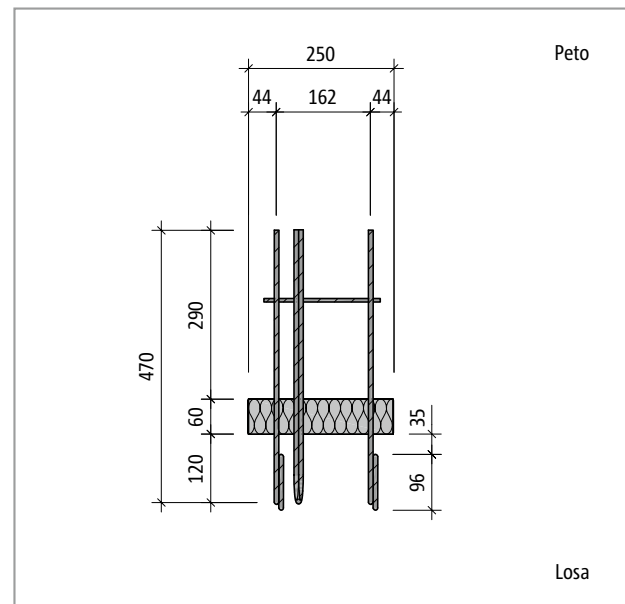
Schöck Isokorb® T tipo A-MM1-X60: Vista del producto
